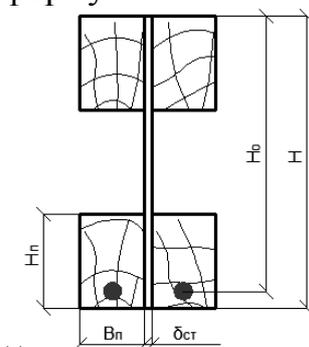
Поперечное сечение армированного клеёфанерного элемента
